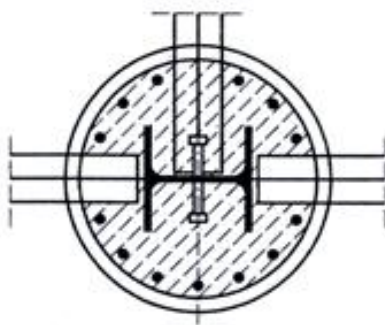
Сопряжение ригелей двутаврового сечения с трубобетонной колонной круглого сечения через проемы в стенке трубы [4]
